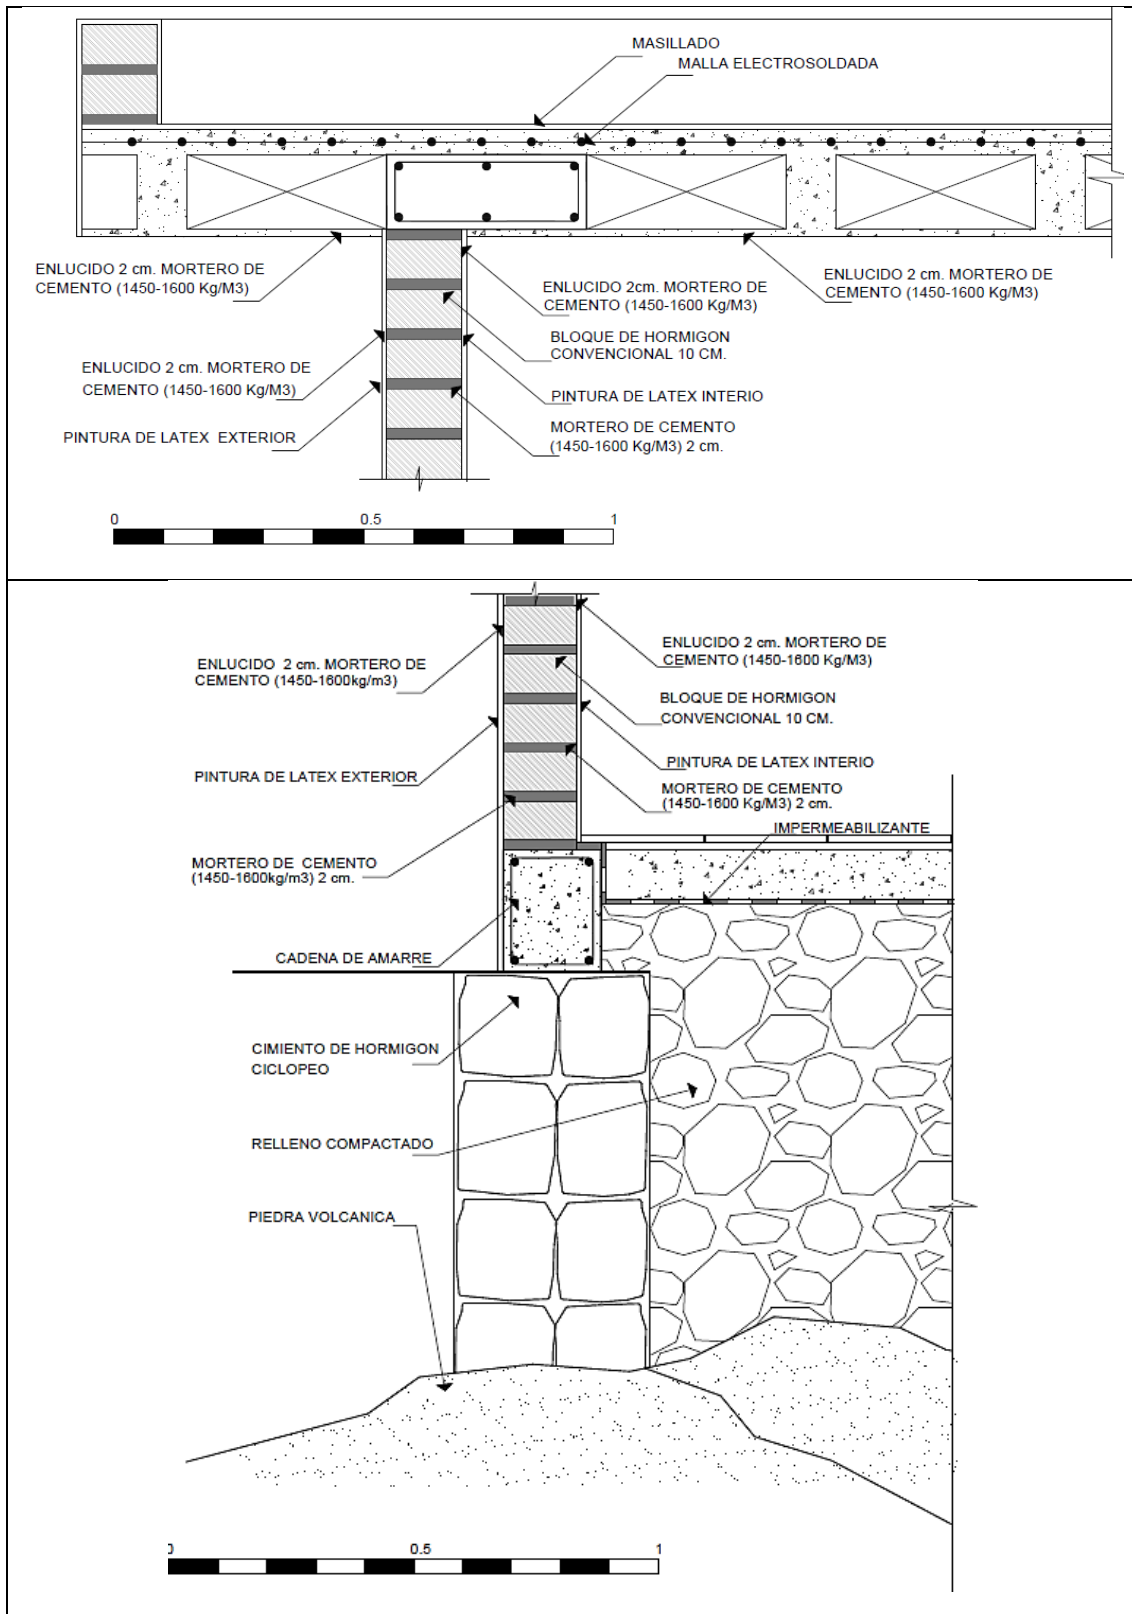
Detalle del sistema constructivo de la pared y de la cubierta de la vivienda 1. Elaboración propia 2017
